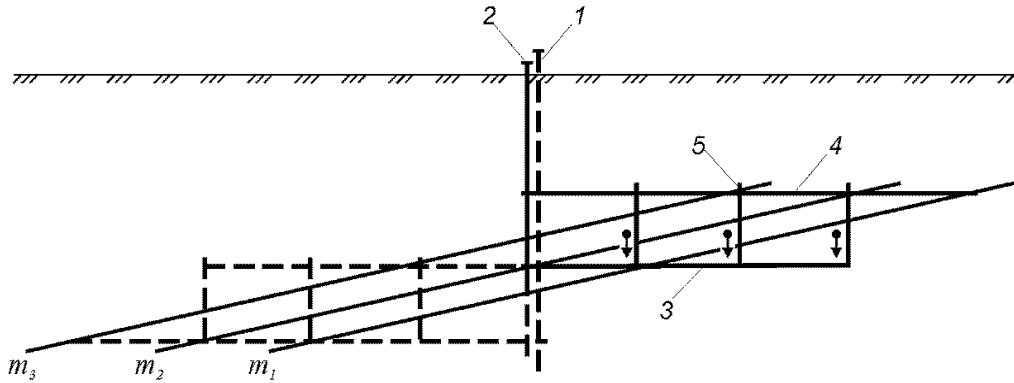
Розкриття шахтного поля вертикальними стволами, погоризонтними квершлагами та поверховими гезенками: 1, 2 – відповідно головний та допоміжний стволи; 3 – транспортний погоризонтний квершлаг; 4 – вентиляційний погоризонтний квершлаг; 5 – поверховий гезенк.
